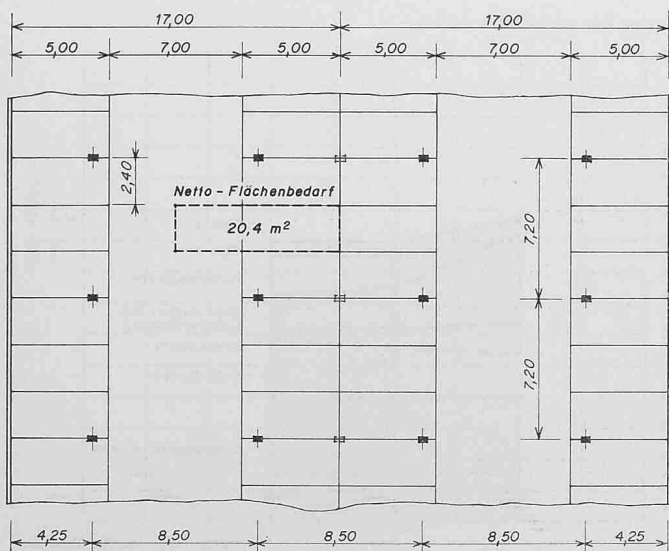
Typischer Grundriss (Ausschnitt) einer unterirdischen Autoabstellanlage
